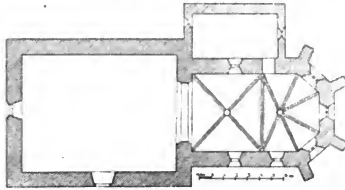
Sepekau. Kirche des hl. Nikolaus. Grundriss.
